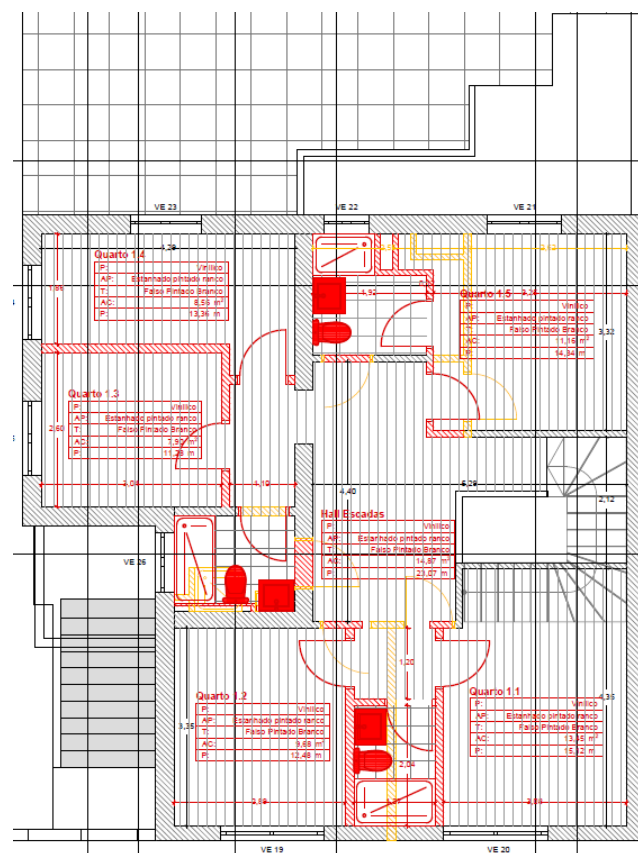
Planta (Vermelhos e Amarelos) Piso 1
